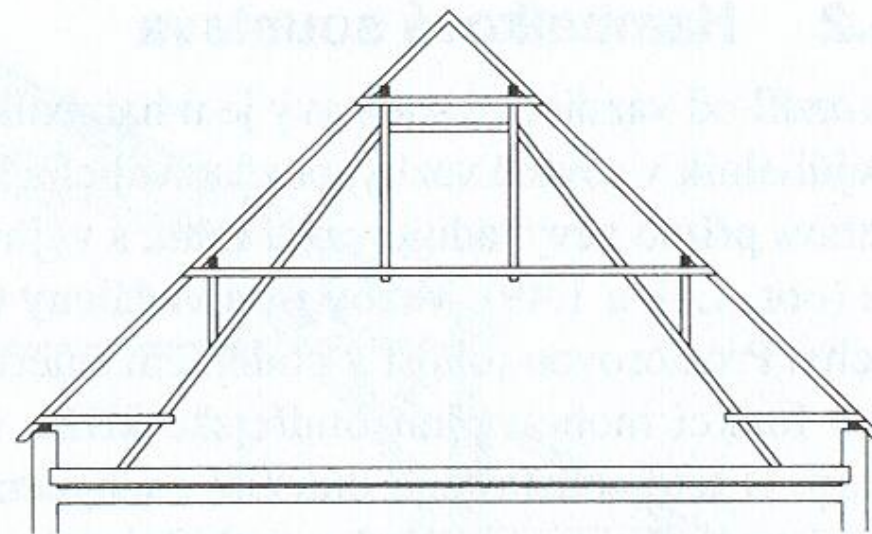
Plná vazba trojitého věšadla pro sedlovou střechu s rozponem 12 až 16 m
